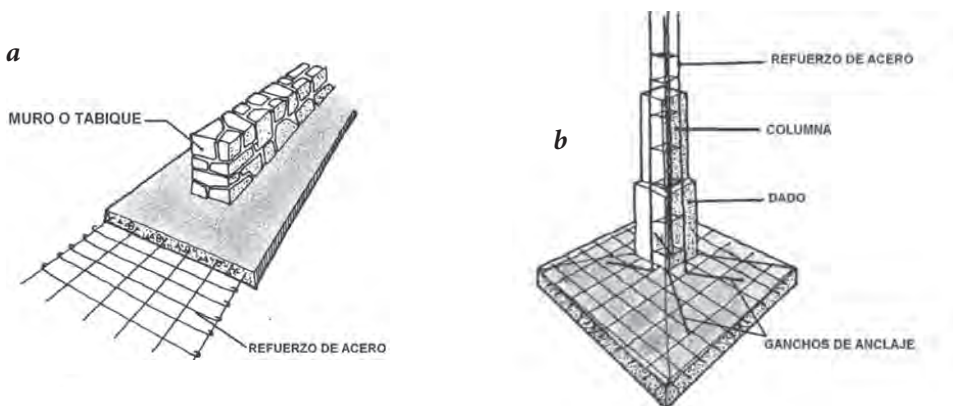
Isometrias de los elementos de sobre cimentación empleados para aislar y confinar los muros de las edificaciones rurales.
